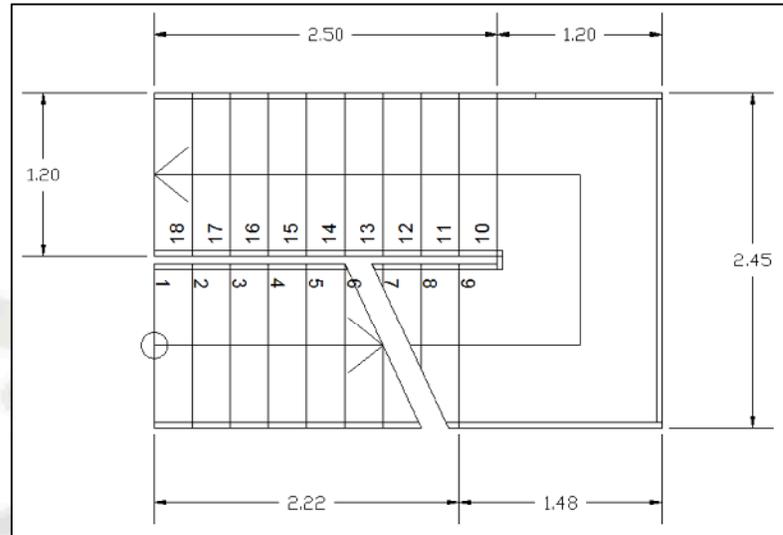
Vista en Planta de la Escalera a Analizar.
